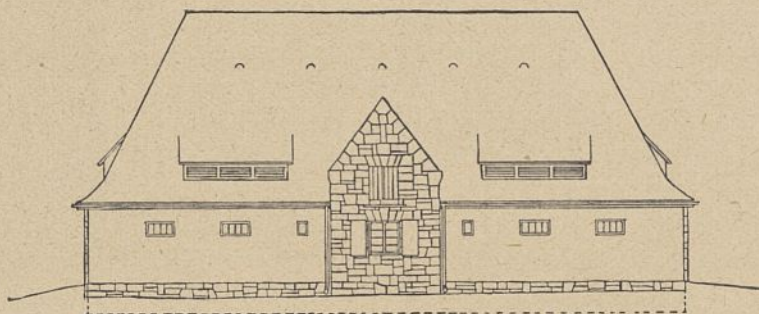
Altefeld, Boxenstall für fremde Stuten.
